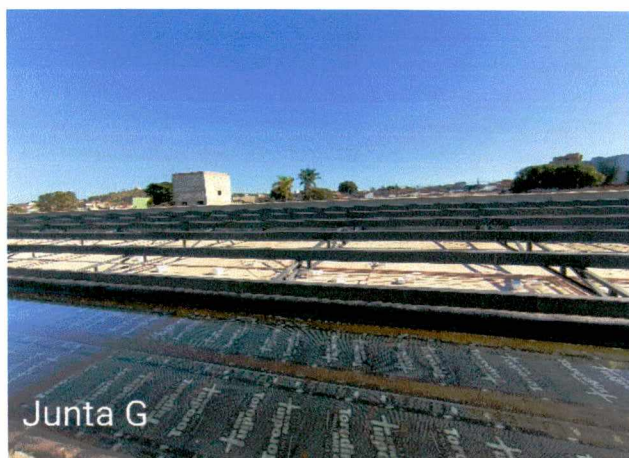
a 20: Montagem do drywall; montagem da estrutura metálica; execução de impermeabilização das calhas;
